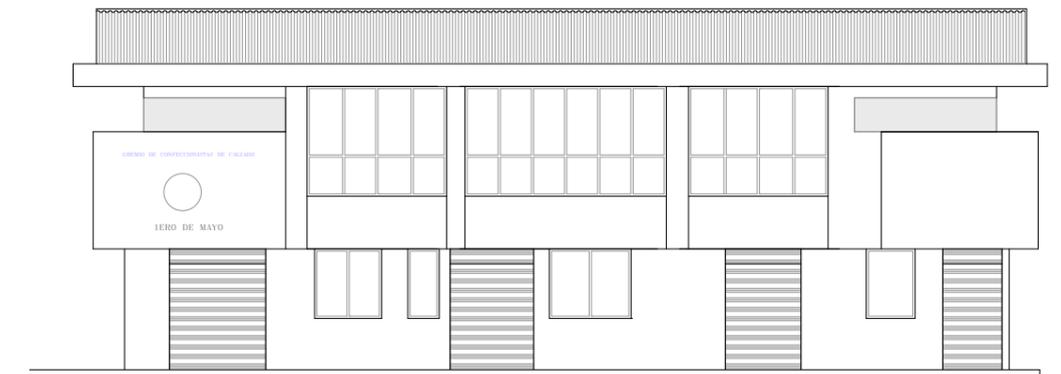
Fachada oeste de la edificio de Gremios de Calzado de Gualaceo. Escala 1:200. fuente, Equipo de tesis.
